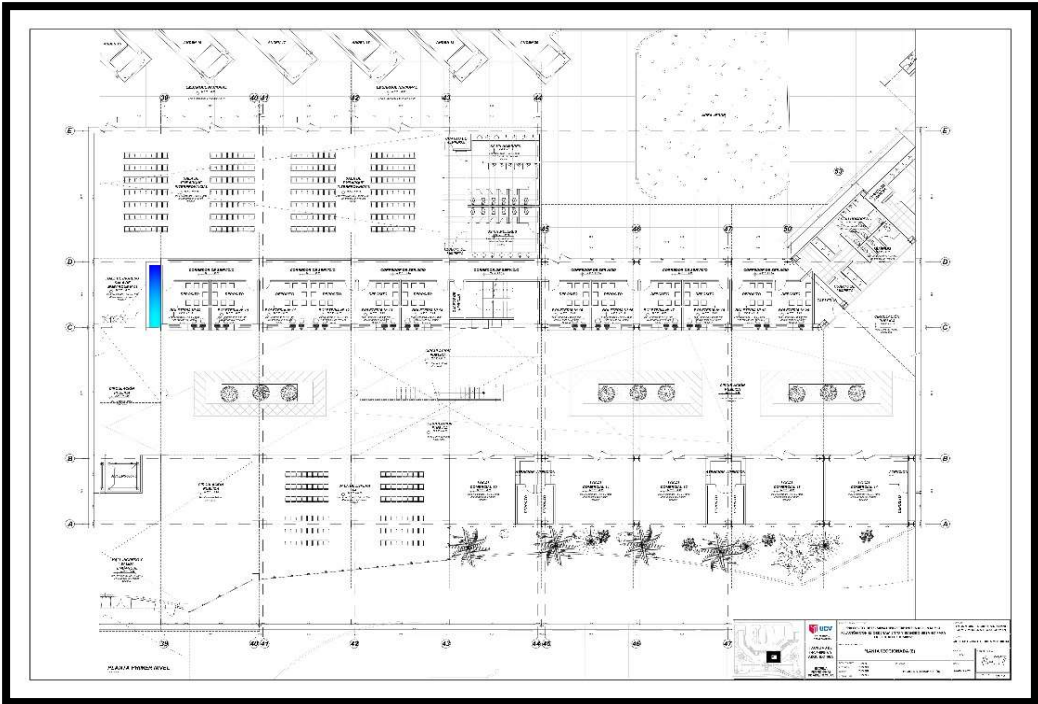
Plano Planta sector (E) Primer Nivel Fuente: Elaboración Propia.
